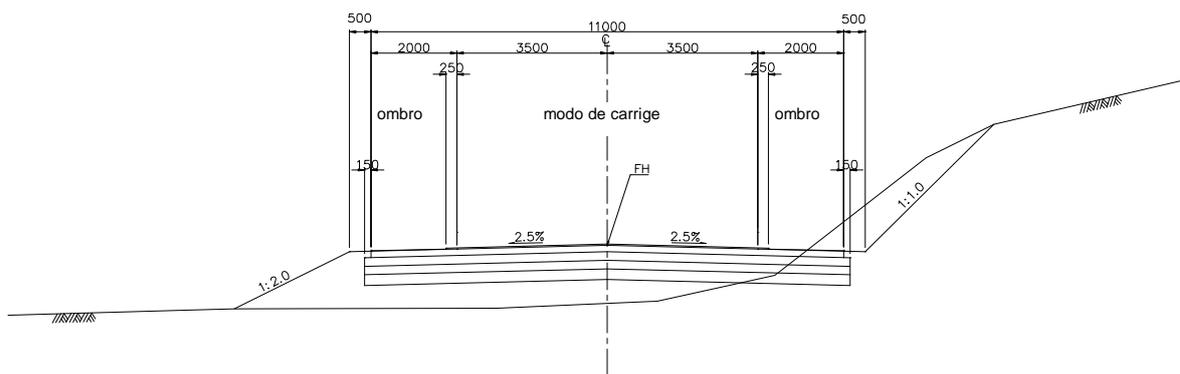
Perfil Transversal Típico Proposto (para Áreas Povoadas)
